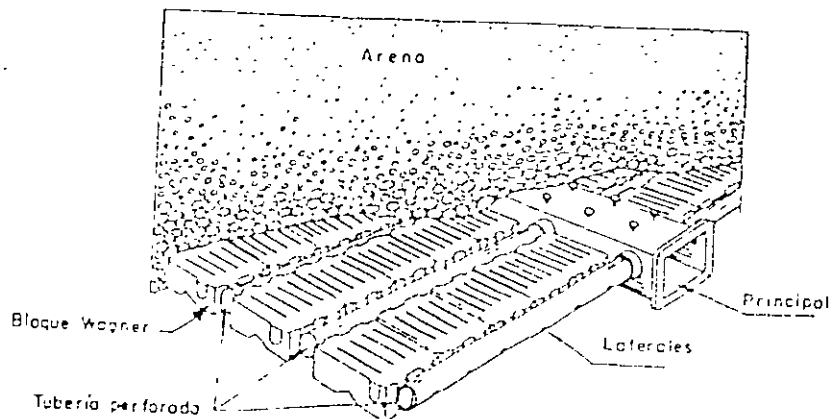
Fondo de tubería con Bloques Wagner (Cortesía de Infilco Inc.)
